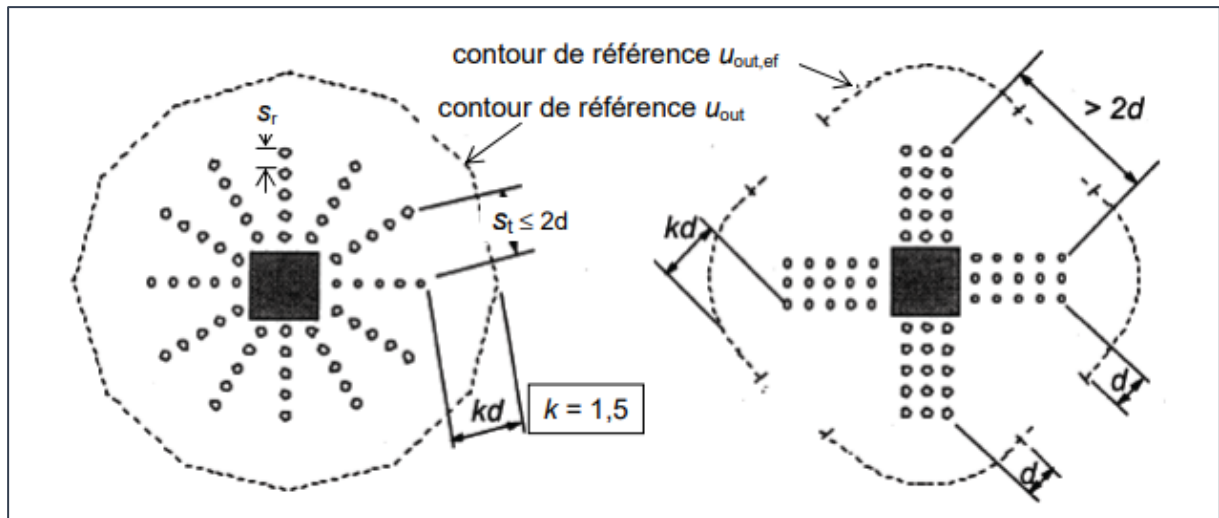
Disposition des armatures de poinçonnement, planchers-dalles
